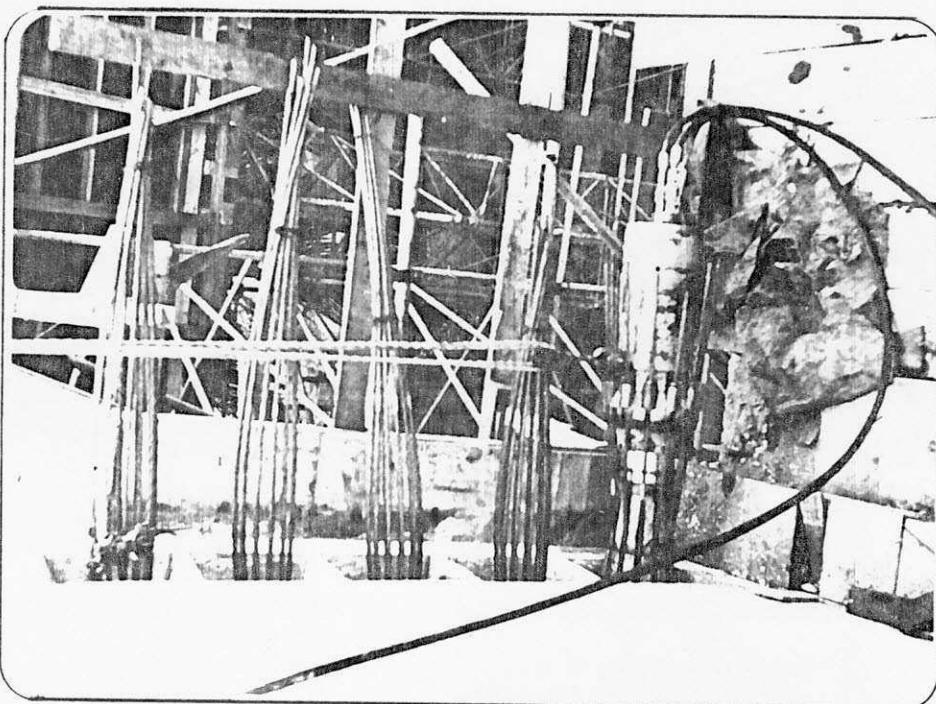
Detalhe de macacos de protensão utilizados no trecho I - Pista Direita.
